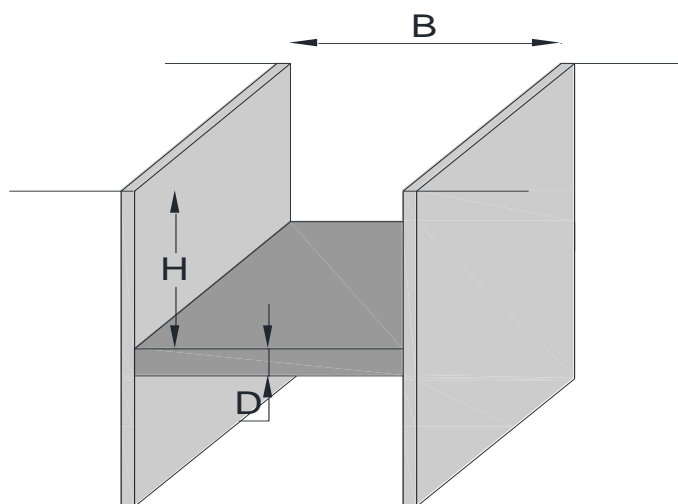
Escavação com solução de "laje" de *jet grouting*.
